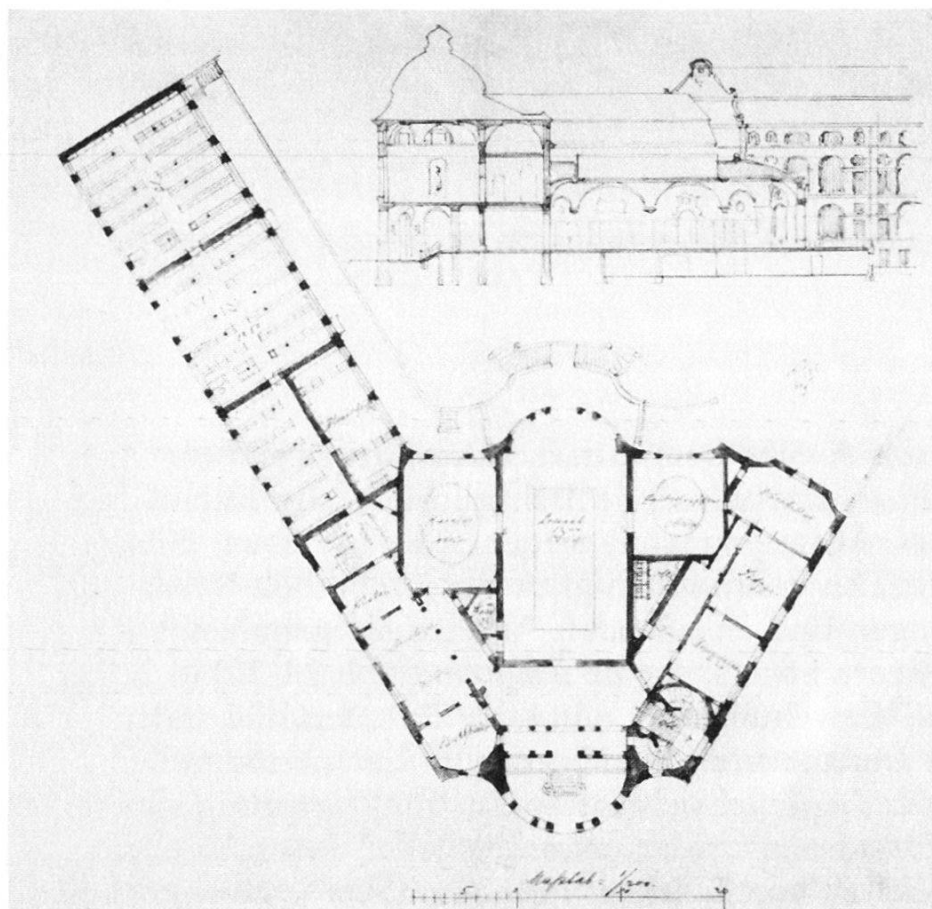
Universitätsbibliothek Basel 1896, Grundriss des Erdgeschosses. Aus einer in den 30er Jahren erstellten Planserie, welche als Grundlage einer allfälligen Erweiterung der Bibliothek dienen sollte. Das ursprüngliche Handschriftenmagazin (rechte Hälfte des ersten Magazinteils) diente seit 1913 als Arbeitsraum für Bibliothekare.
